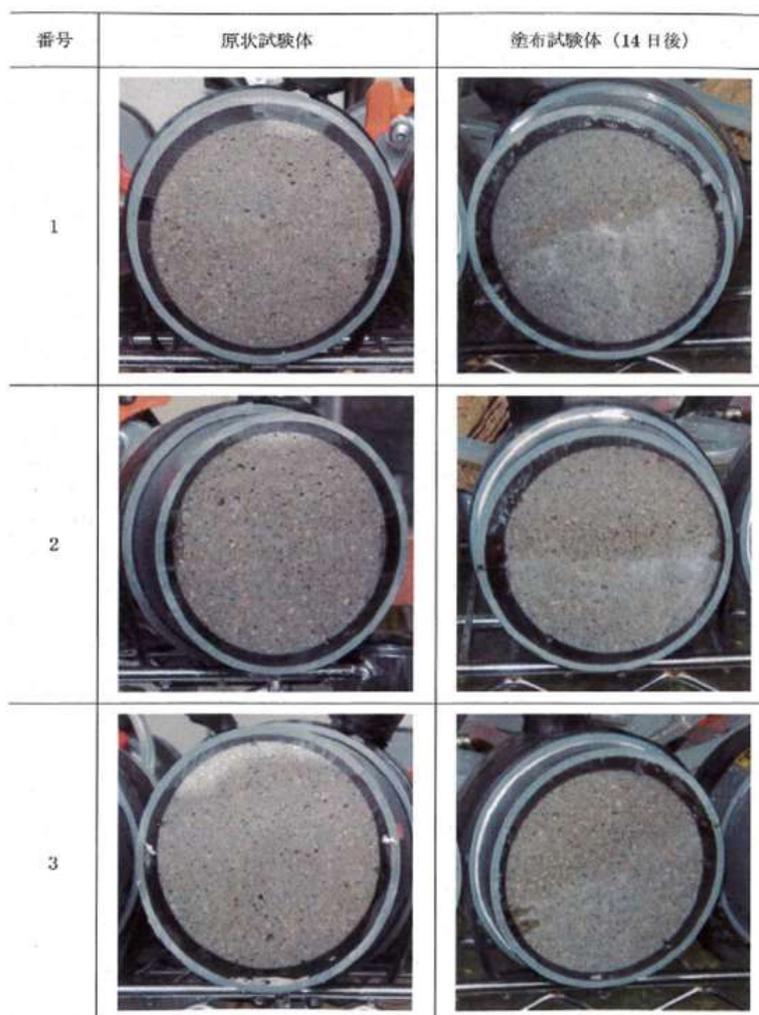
ひび割れ透水性試験完了状況（モルタル）
